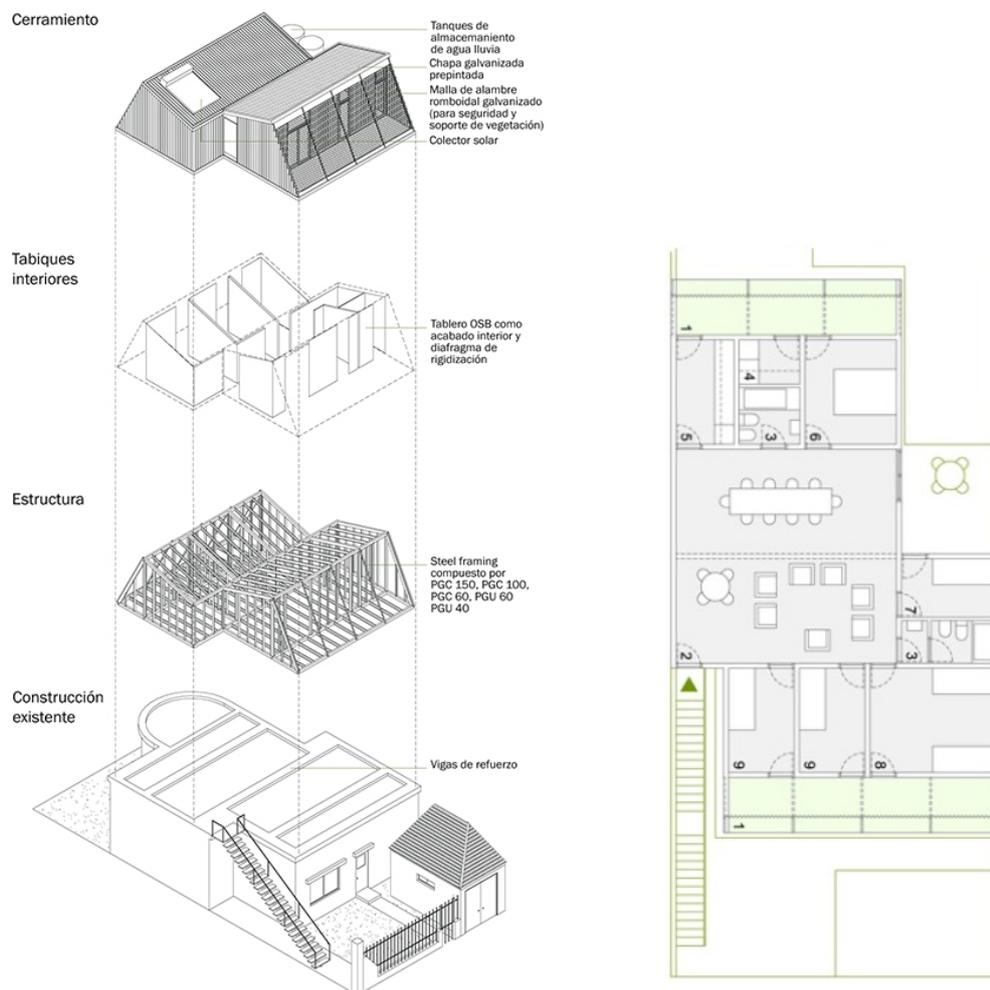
Axonométrica, planta de ensamble y componentes de una casa tipo de una casa proyectada sobre una vivienda del barrio La Matanza, en Buenos Aires.
